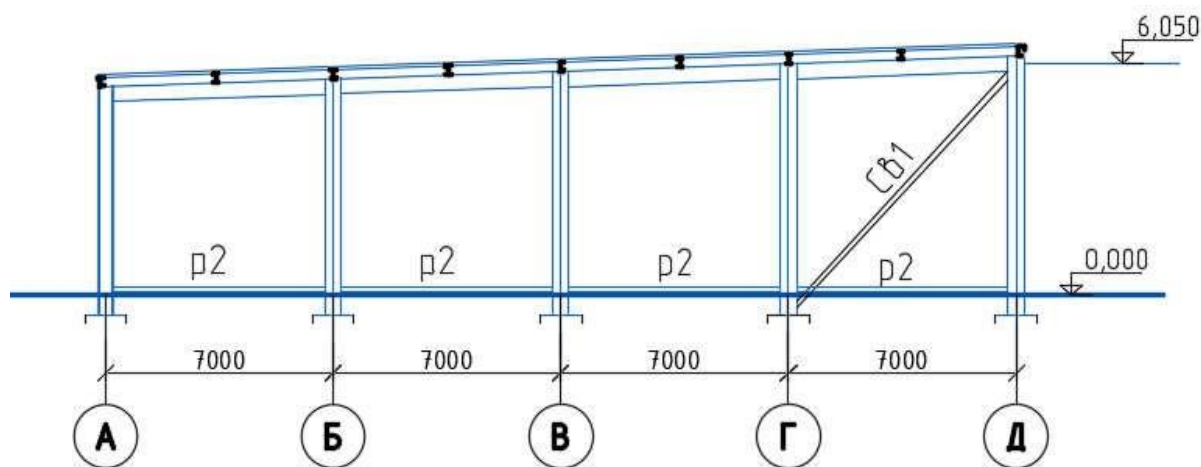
Компоновочная схема поперечной рамы здания
